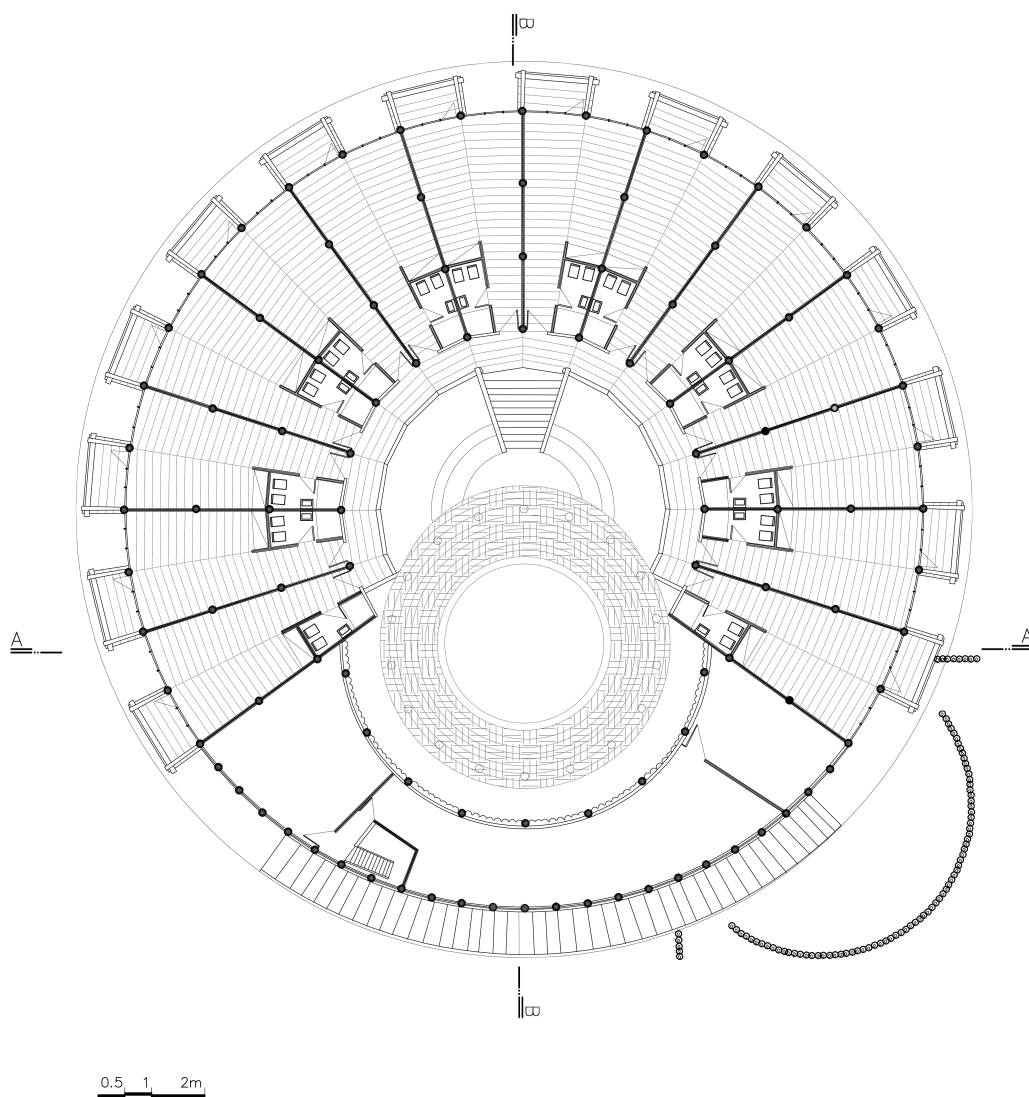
Pousada da Ilha de Silves. Planta Segundo pavimento, 2017.
